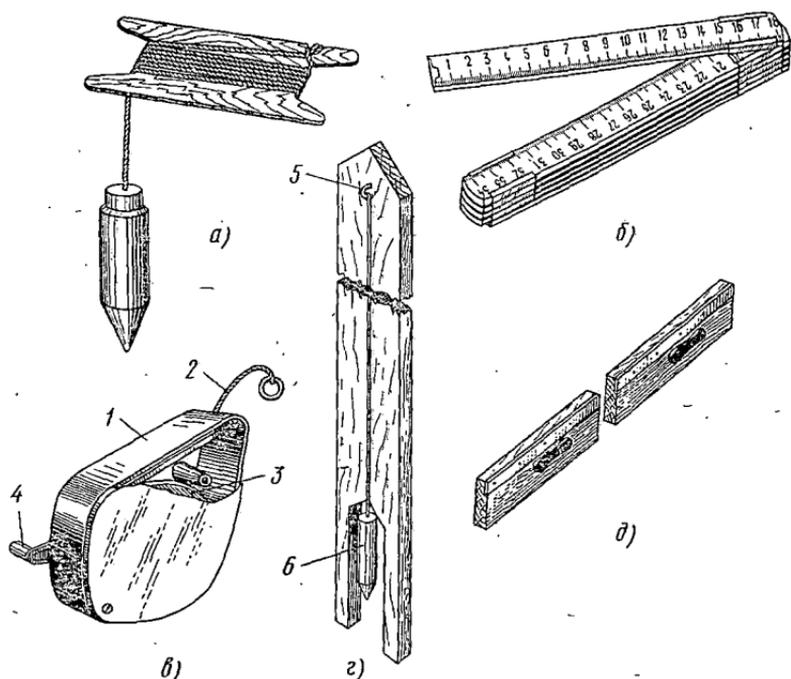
Контрольно-измерительные инструменты и приспособления для провешивания стен:
